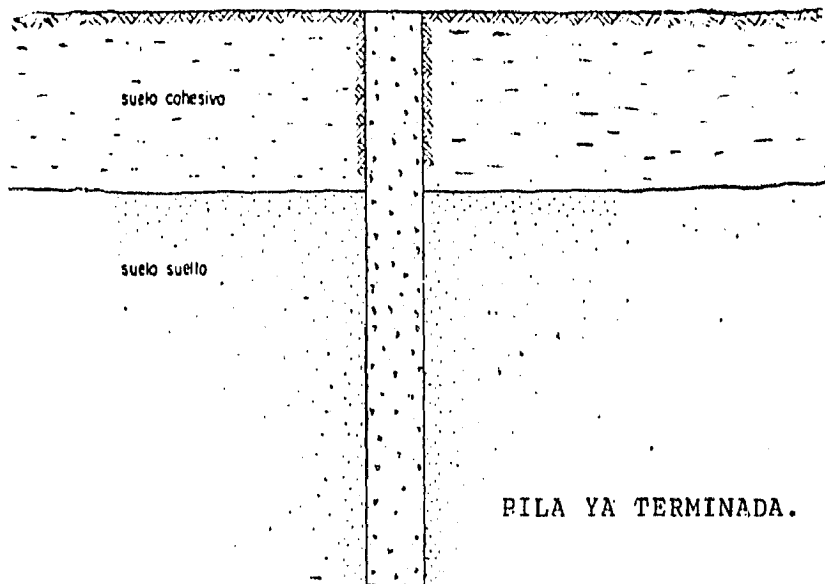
C COLADO DE PILAS SIN ADEME METÁLICO CON TUBERIA TREMIE BAJO LODOS BENTONÍTICOS CON RECUPERACIÓN DE LOS MISMOS,
